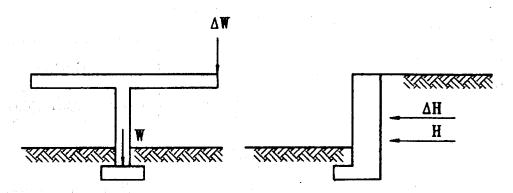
الأجزاء من مساحة الأساسات التي تعمل في نقل الأحمال من الأساس إلى التربة
